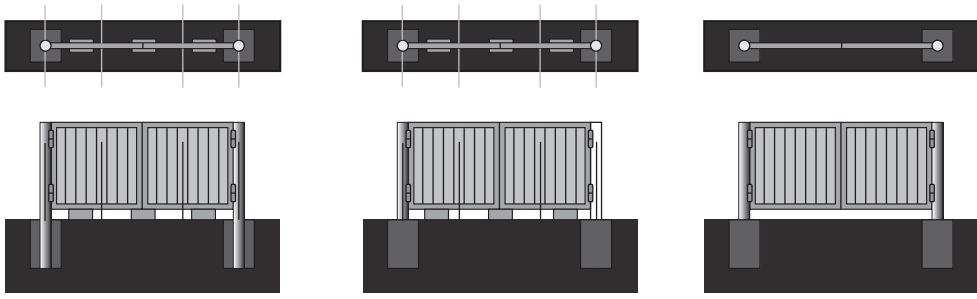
Установка распашных ворот с несъемной конструкцией
